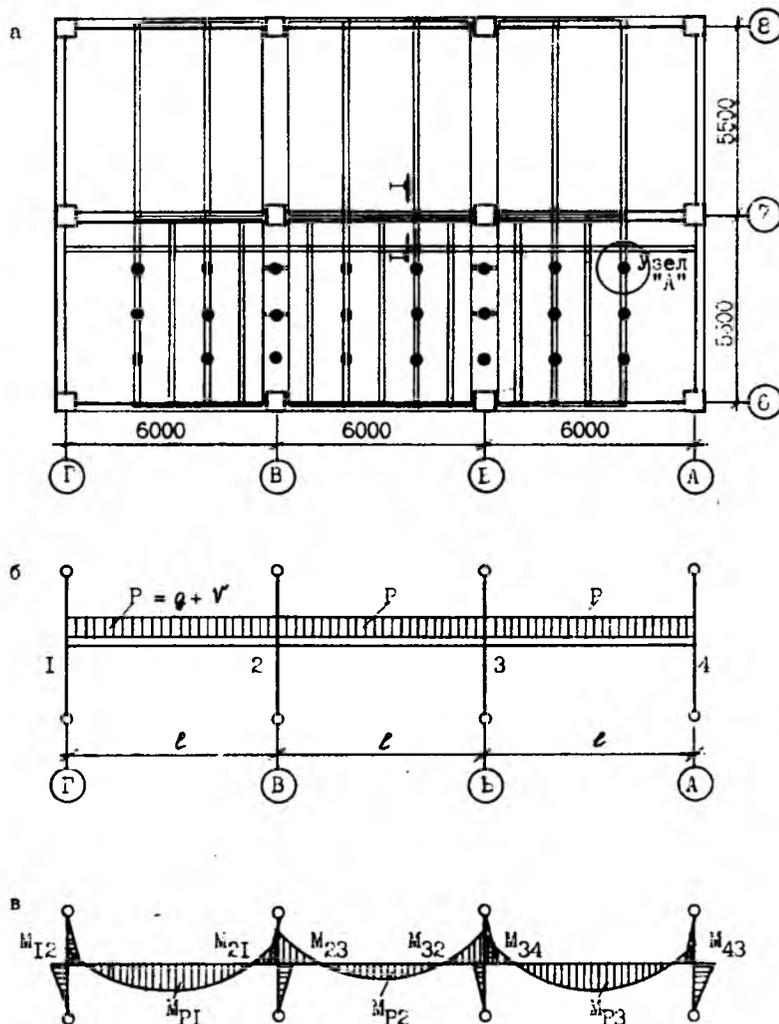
План перекрытия сиропного отделения со схемой усиления
